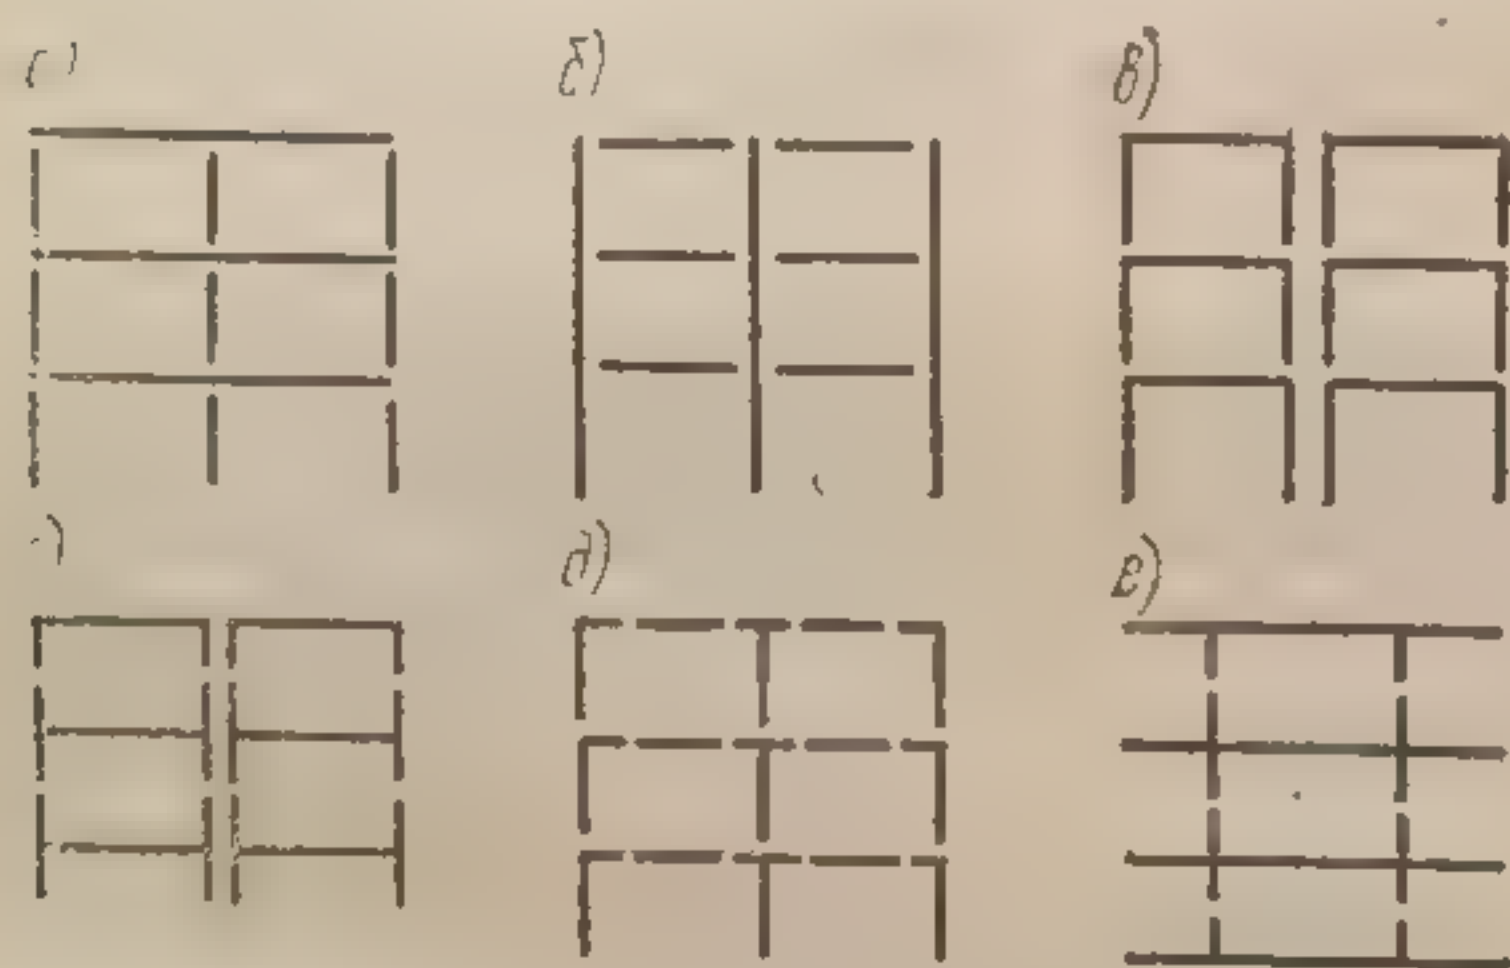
Схемы членения железобетонных каркасов на элементы:
